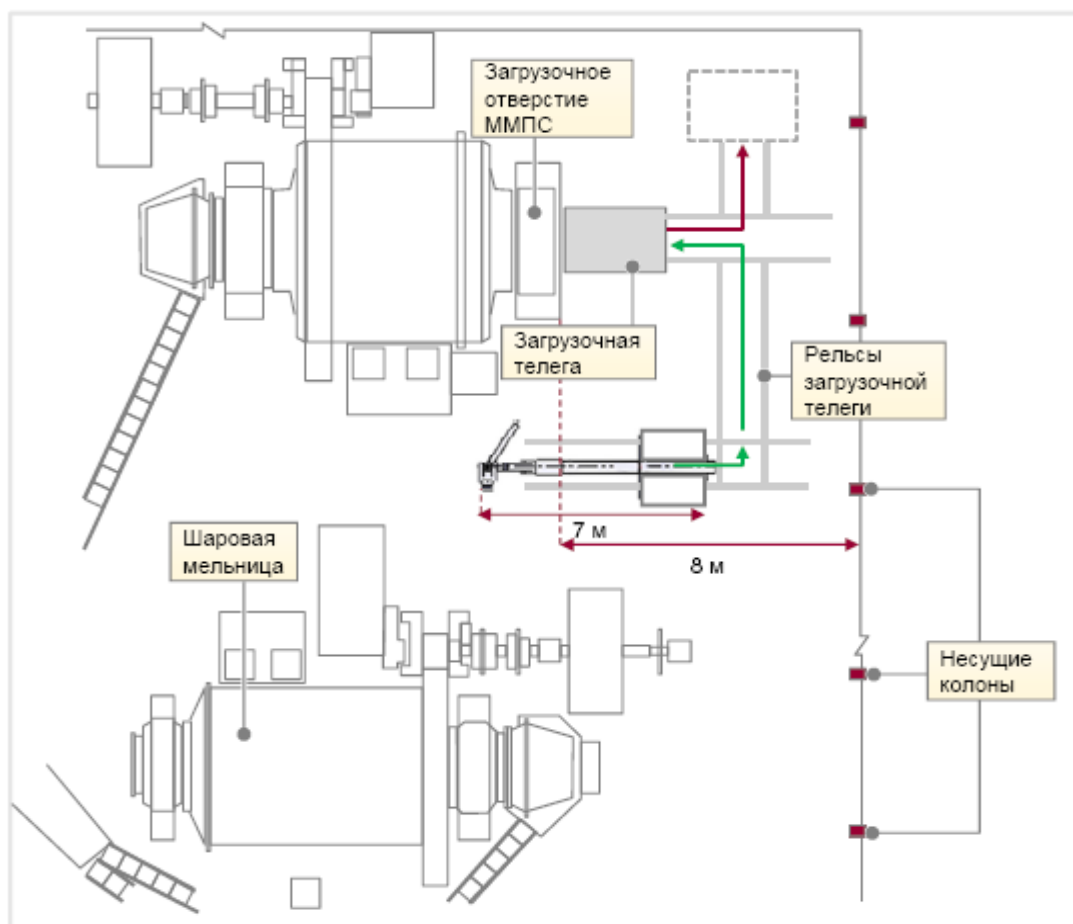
Схема монтажной площадки размещения футеровочной машины на ЗИФ-3.
